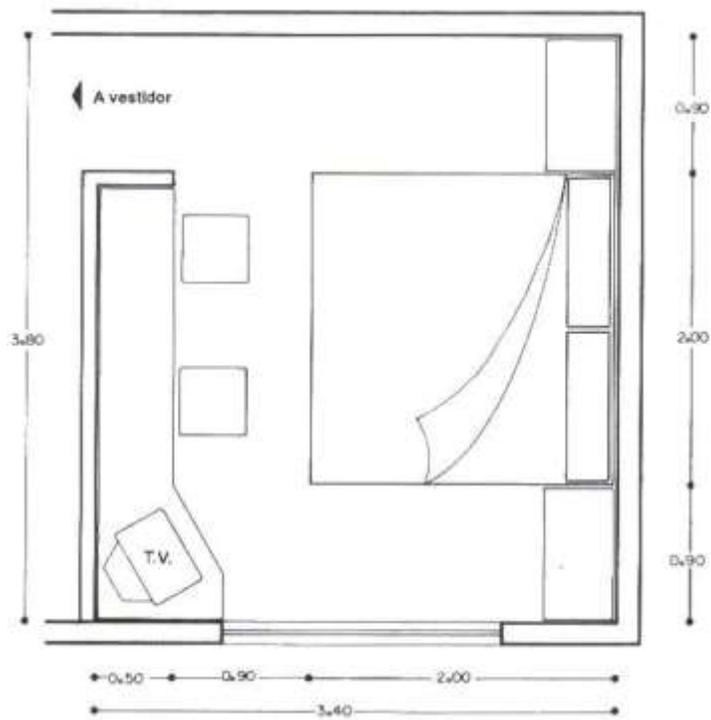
Dimensiones de recámara sin closet y cama king size.
